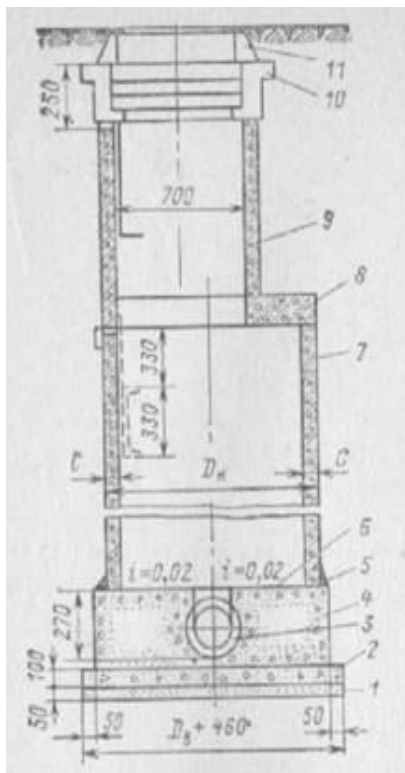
Сборный круглый железобетонный смотровой колодец в разрезе:
